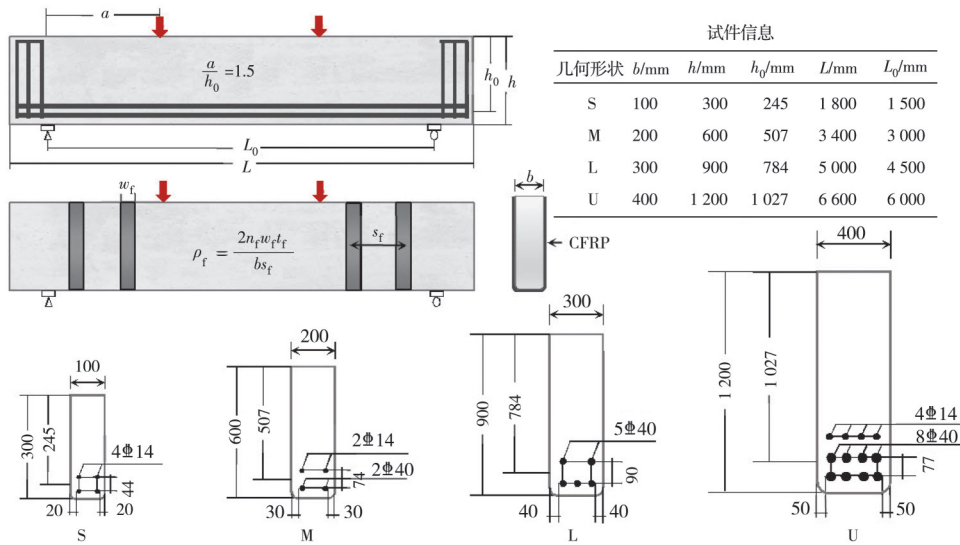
试件内部钢筋及外贴 CFRP 条带布置示意图
